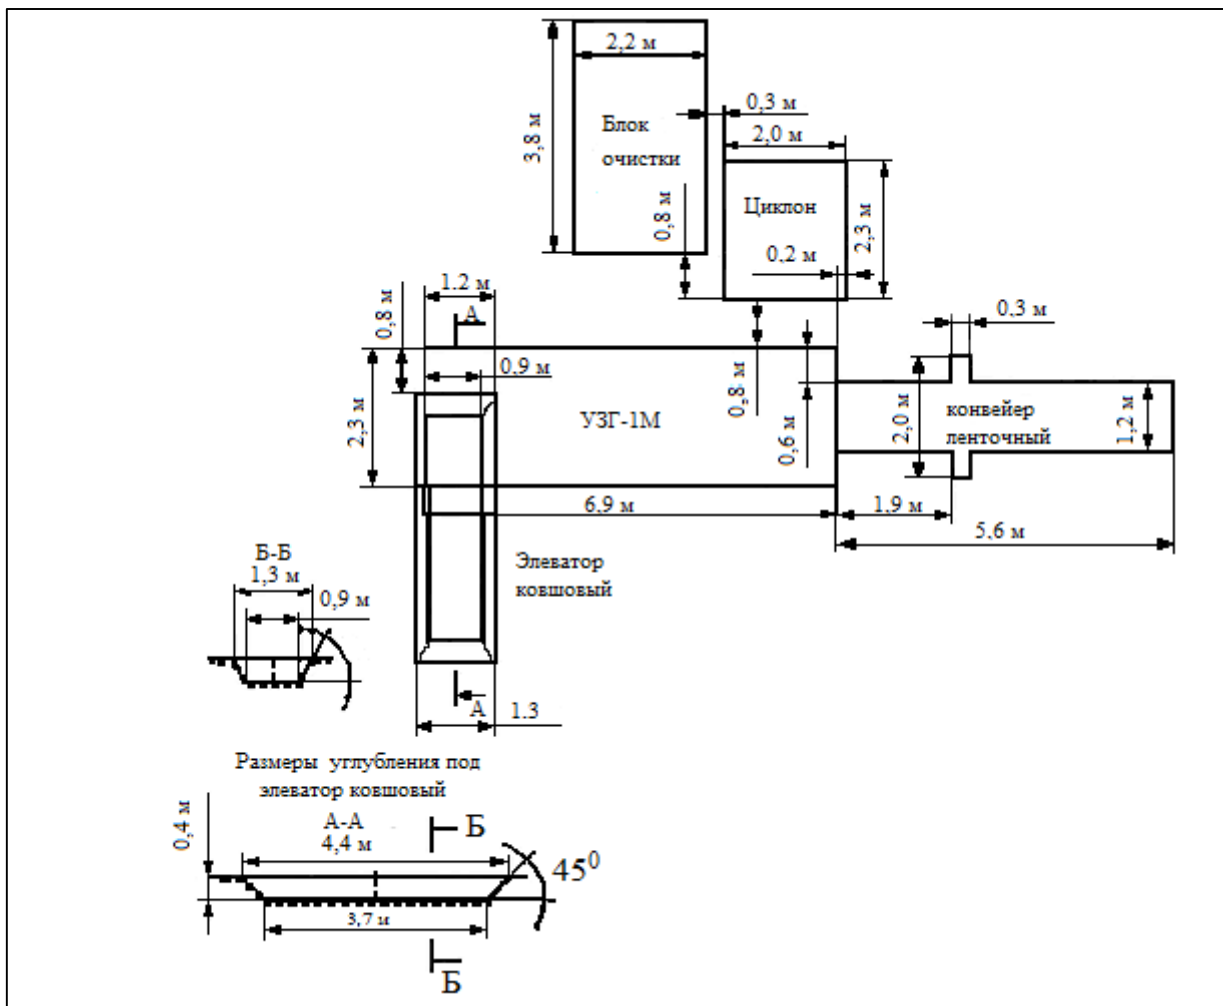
Технологическая схема площадки при монтаже установки «УЗГ-1М»
